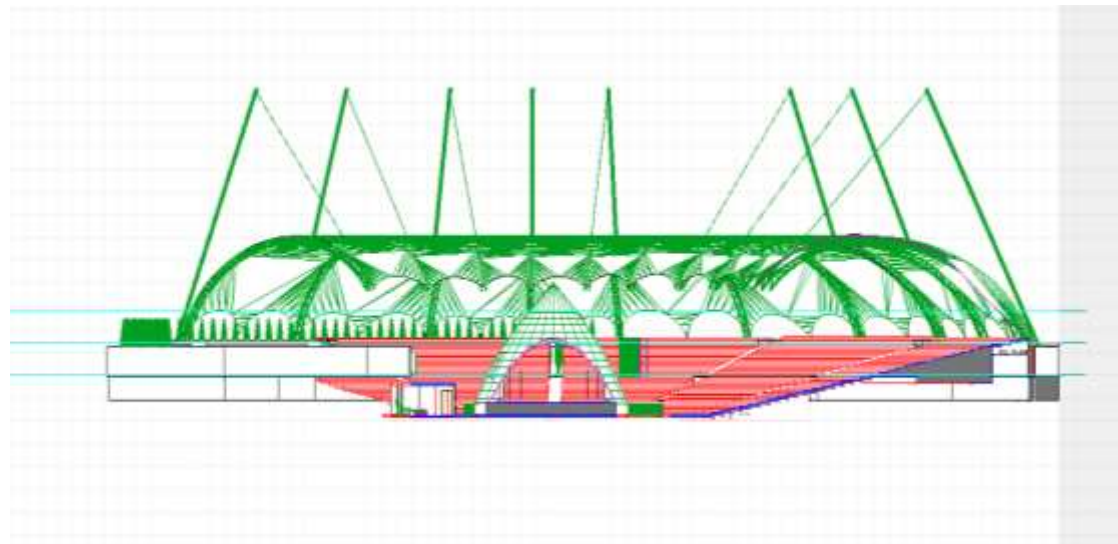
CORTE TRANSVERSAL EN 3D AROCHE 2022.
